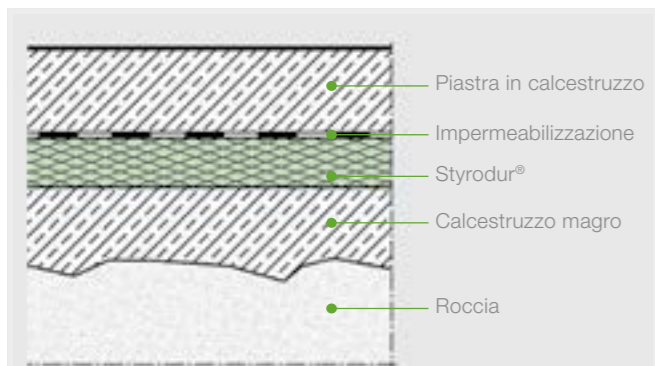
Strato di compensazione in calcestruzzo magro per terreno di fondazione roccioso.
